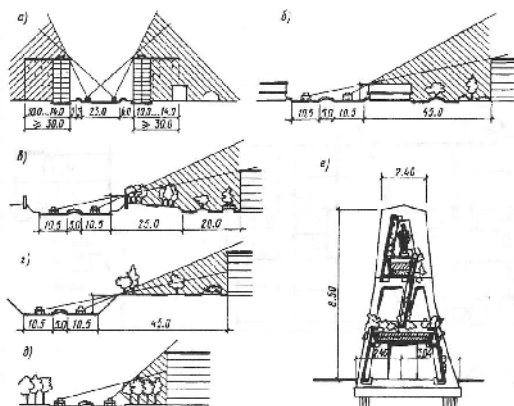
1) разрабатываемые меры защиты от шума в шумозащитных домах, б – экранизирующей малоэтажной застройкой; в – шумозащитными стенками – экранами; г – размещением транспортных магистралей в выемках; д – озеленением; е – схема сечения железобетонной стенки экрана с озеленением и устройством в нижней зоне экрана тарней. Шриховской обозначена зона “акустической тени”
